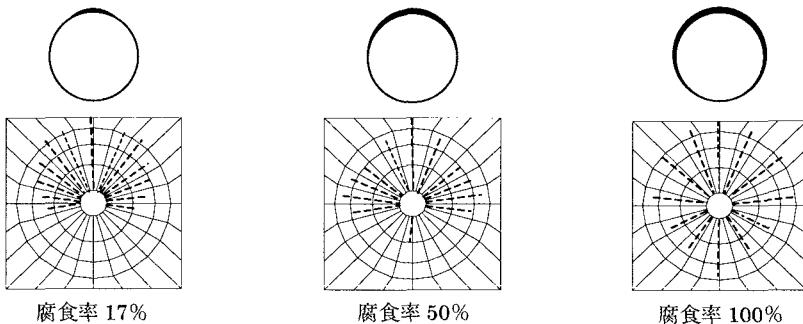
鉄筋腐食率とコンクリート断面の想定ひび割れ
